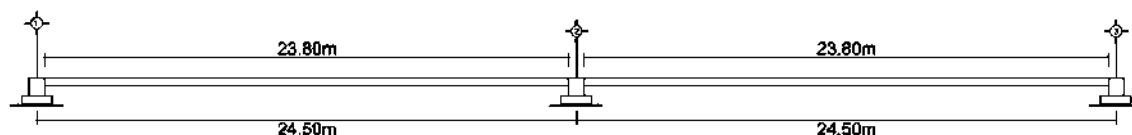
(a) Vista en alzado de la cimentación, eje transversal
